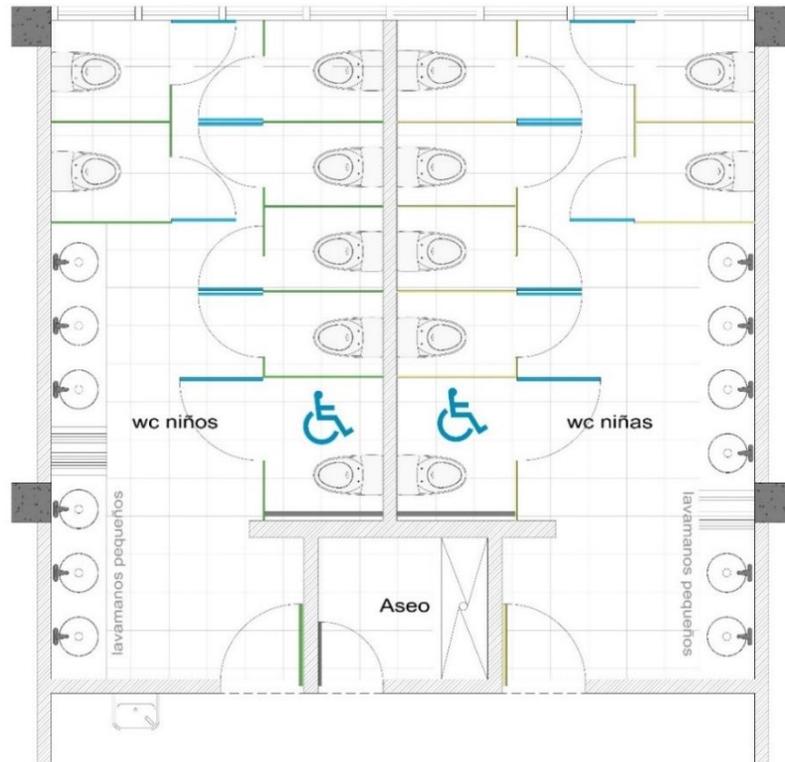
Plano baños primer piso colegio Gimnasio Superior.
